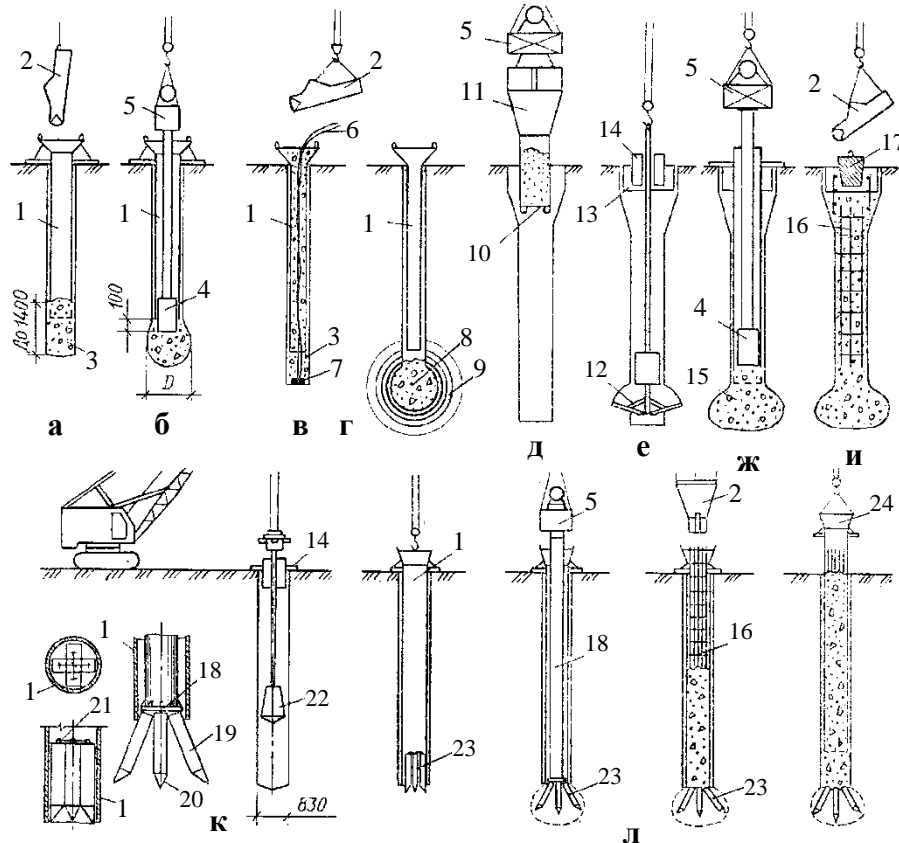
Розширення площі оперття набивної палі та бурової опори: а – засипання в свердловину жорсткої бетонної суміші; б – утрамбовування суміші в ґрунті; в – закладання заряду вибухової речовини та заповнення свердловини пластичною бетонною сумішшю; г – утворення розширення вибухом заряду; д – розбурювання верхнього розширення для стакана опори-колони; е – розбурювання нижнього розширення; ж – утрамбовування жорсткої бетонної суміші в ґрунт основи; и – формування опори-колони та стакана; к – конструкція пакета свайок (їхнє розположення після забивання); л – схема улаштування бурової опори з коренеподібною основою; 1 – інвентарна обсадна труба; 2 – цебер з бетоном; 3 – бетонна суміш; 4 – вібраційне трамбування; 5 – вібраційний занурювач; 6 – дроти до підривної машини; 7 – заряд вибухової речовини; 8 – камуфлетне розширення; 9 – ущільнена ґрунтова оболонка; 10 – дно розширювача, що відкривається; 11 – розширювач гирла свердловини; 12 – розширювач основи свердловини; 13 – інвентарна опалубка; 14 – буровий кондуктор; 15 – повторне розширення трамбуванням; 16 – арматурні сітки; 17 – форма стакана; 18 – сталеві щогли з опорною плитою; 19 – крайня свайка з одностороннім скосом; 20 – середня свайка з симетричним вістря; 21 – стропильні скоби й в'язі; 22 – ківшевий бур; 23 – пакет свайок; 24 – витягання обсадної труби та формування оголовка
